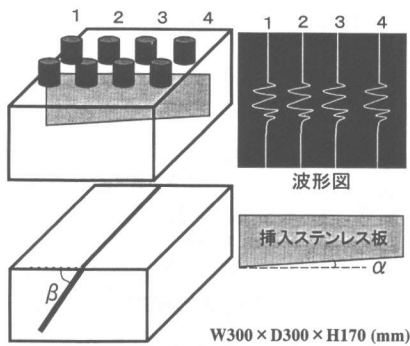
斜めひび割れ供試体の形状と測定方法
